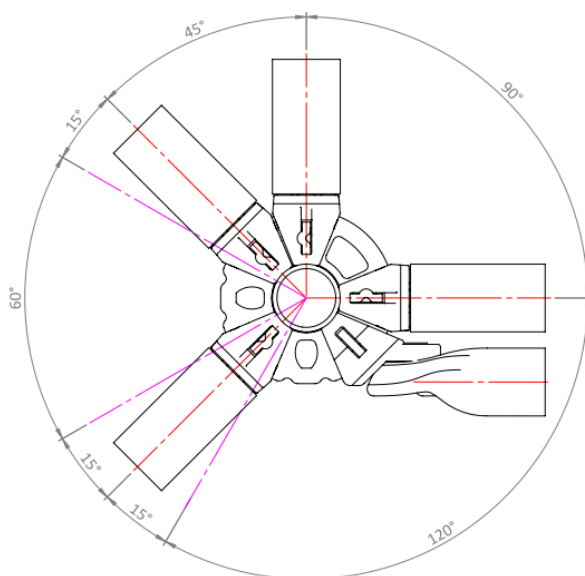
Grundriss DokaScaff-Knoten
